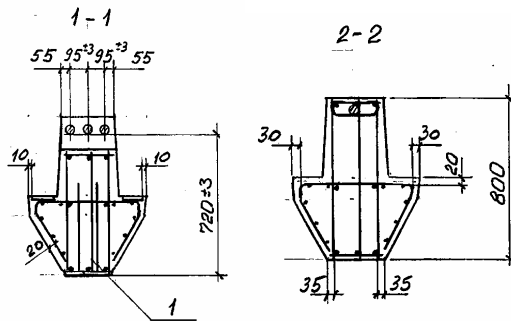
Опорное и пролетное сечения ригеля: 1 – плоский каркас пространственного каркаса
